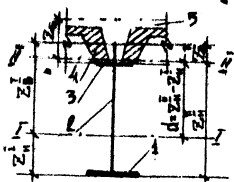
Компоновка сечений комплексных балок междуэтажных перекрытий под большую временную нагрузку: 1-нижняя полка тавра; 2-стенка; 3-продольные ребра жесткости; 4-сборные железобетонные плиты; 5-замоноличивающий бетон.
